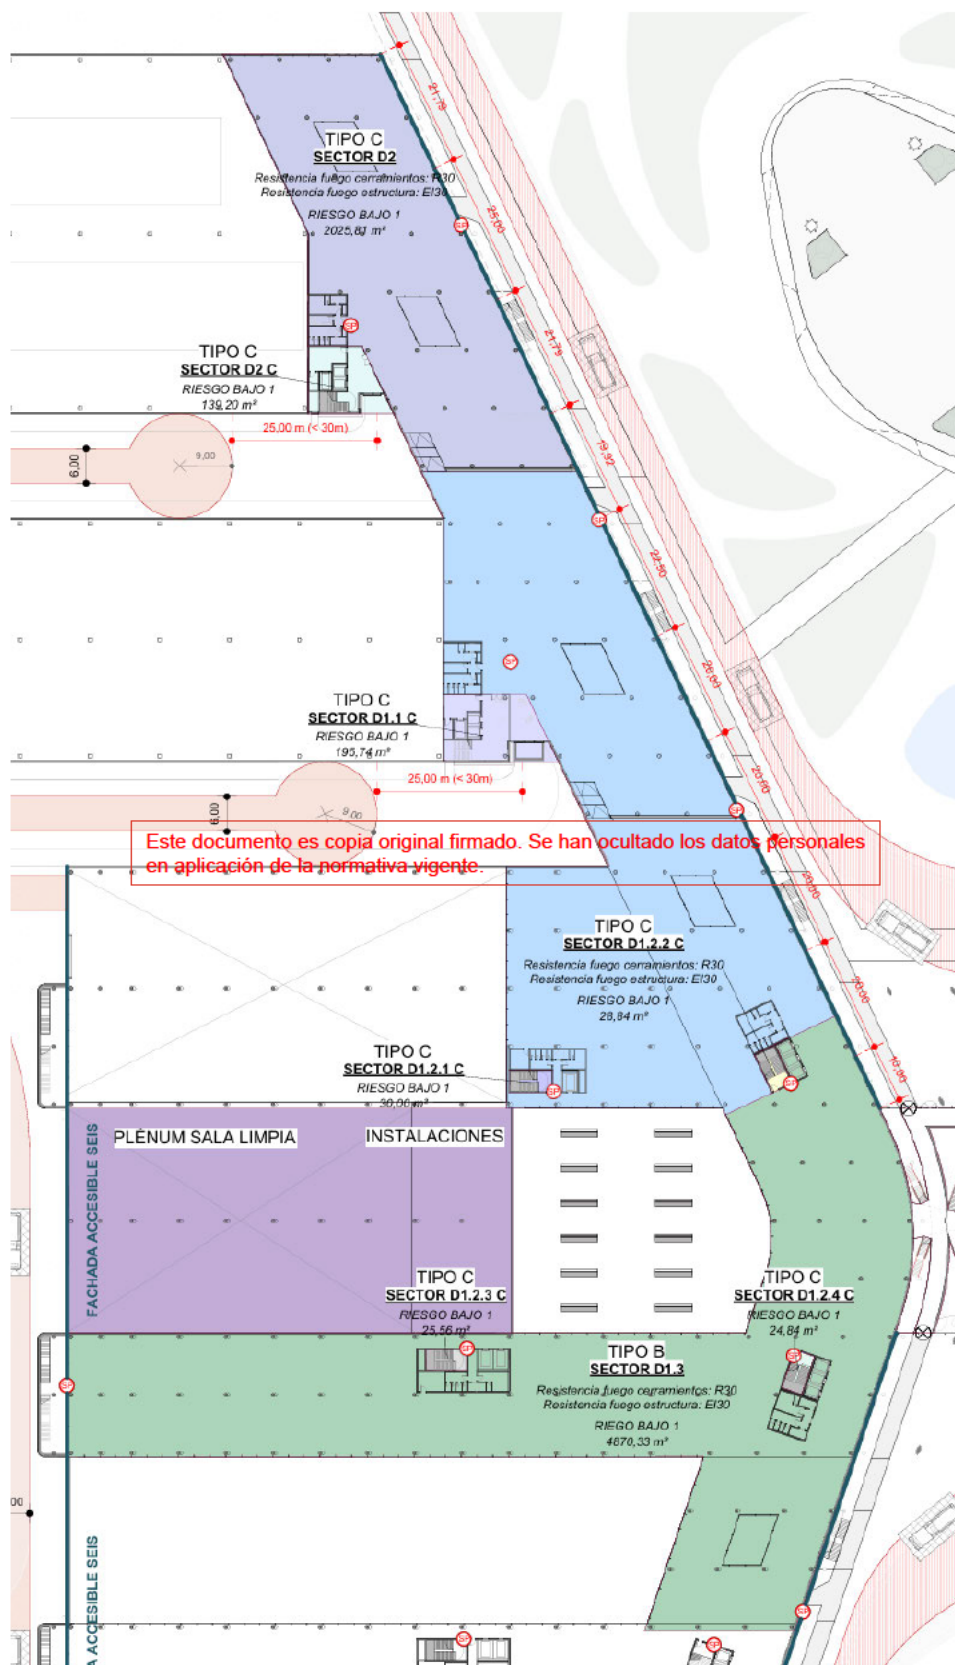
sectorización de los edificios D1 y D2 en planta primera
